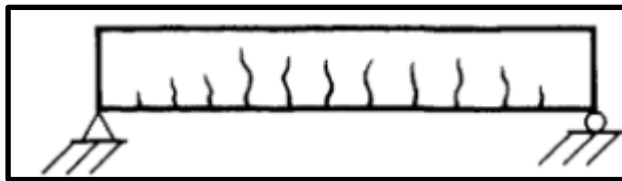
Diagram jenis retak beton (Lani Djakranata, 2021)
